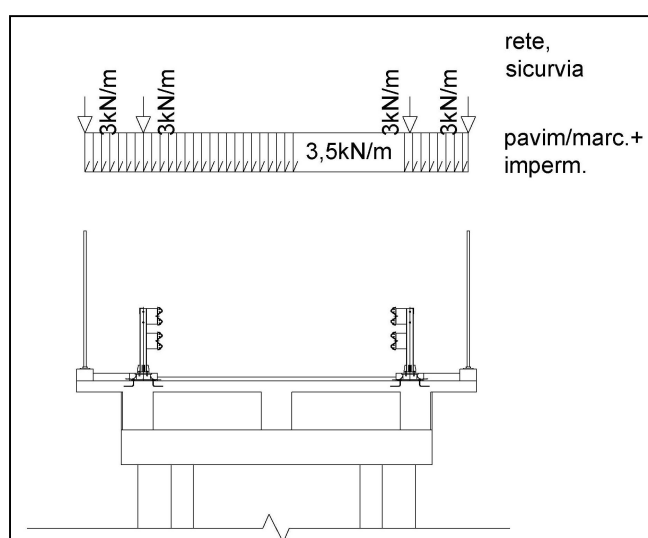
Disposizione trasversale carichi permanenti portati rampe
